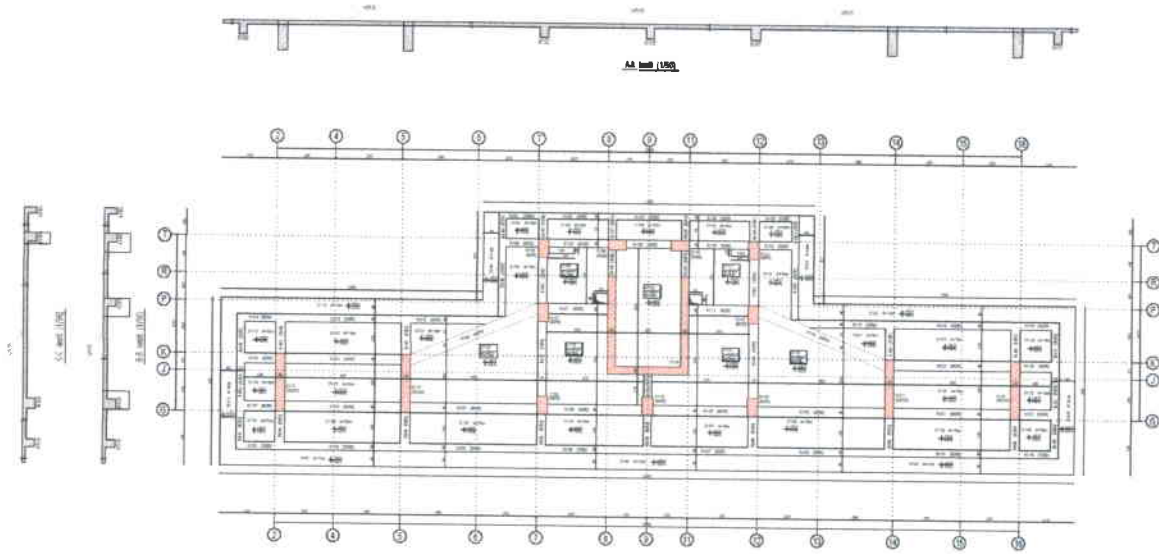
A2 blok 2.Bodrum Kat Kalıp Planı
